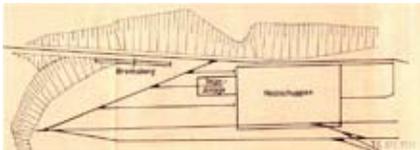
Lageplan Imprägniergebäude auf dem erweiterten Holzplatz. Bergarchiv Clausthal
